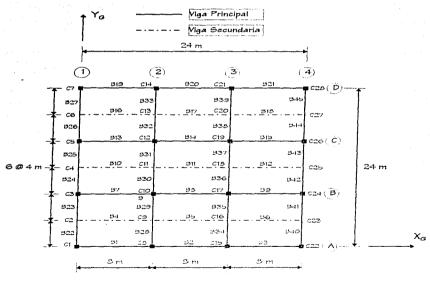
Planta tipo de la cetructura de 17 niveles (ubicación de vigas y columnas)
